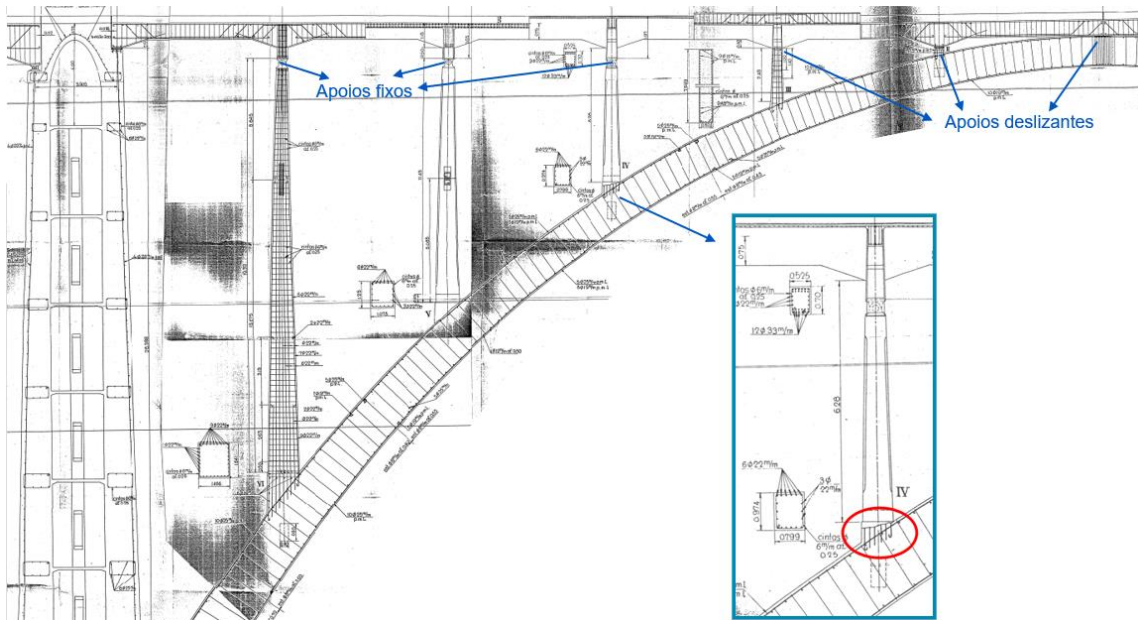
Estrutura do arco central mostrando a amarração insuficiente da armadura de pilares.
